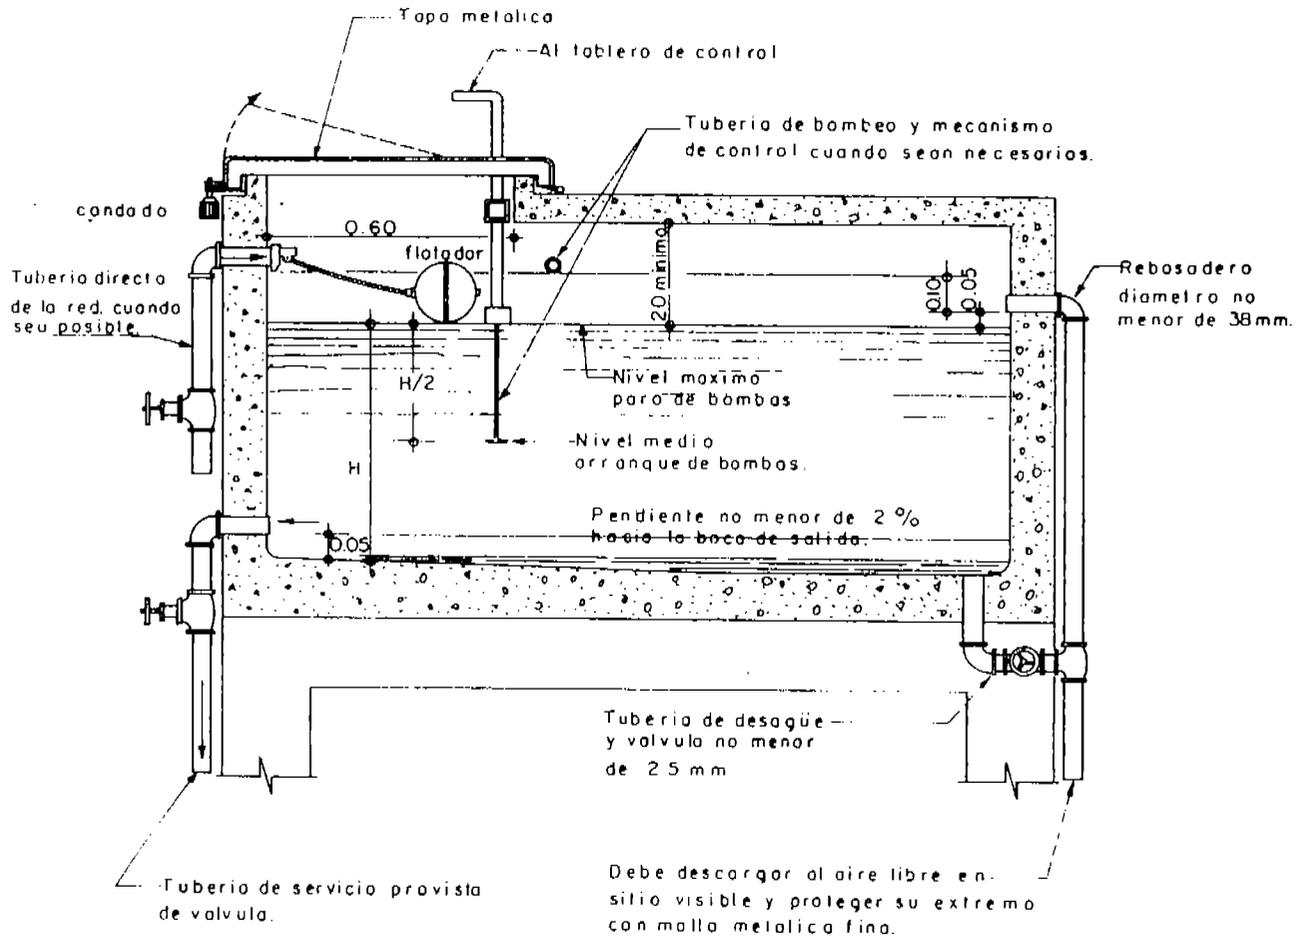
CROQUIS DE UN TANQUE ELEVADO
